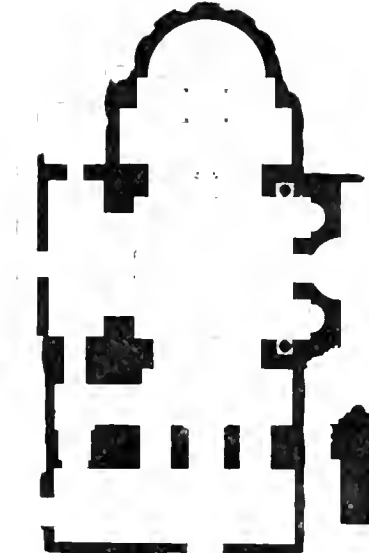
Grundriss, aufgenommen von Strzawski
